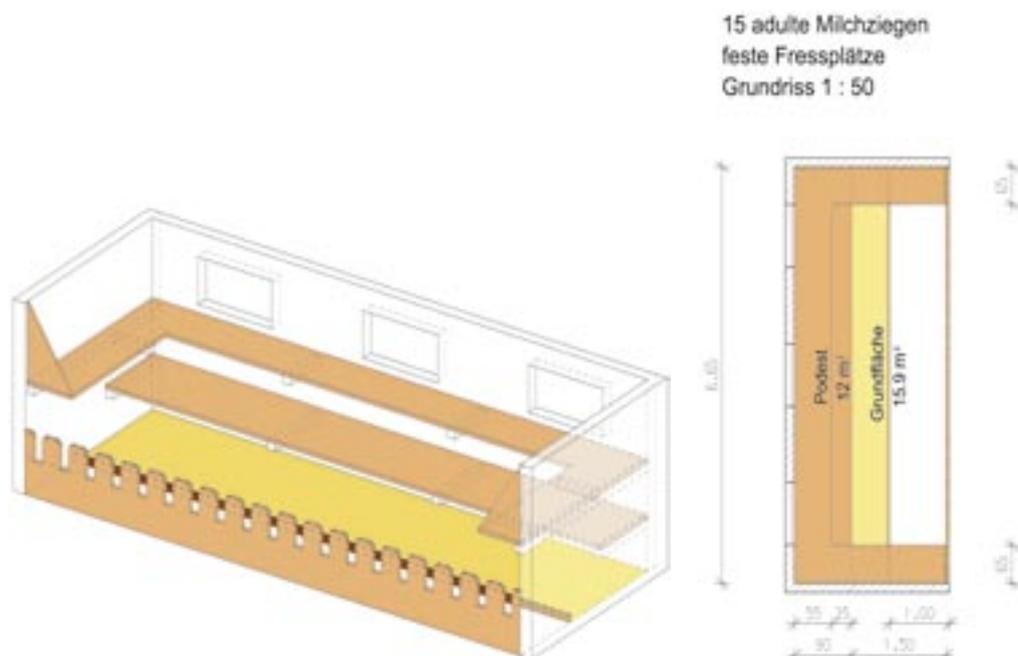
a und b: Modellstall für 15 erwachsene Ziegen, Perspektive (a) und Grundriss (b) mit Vermassung.
